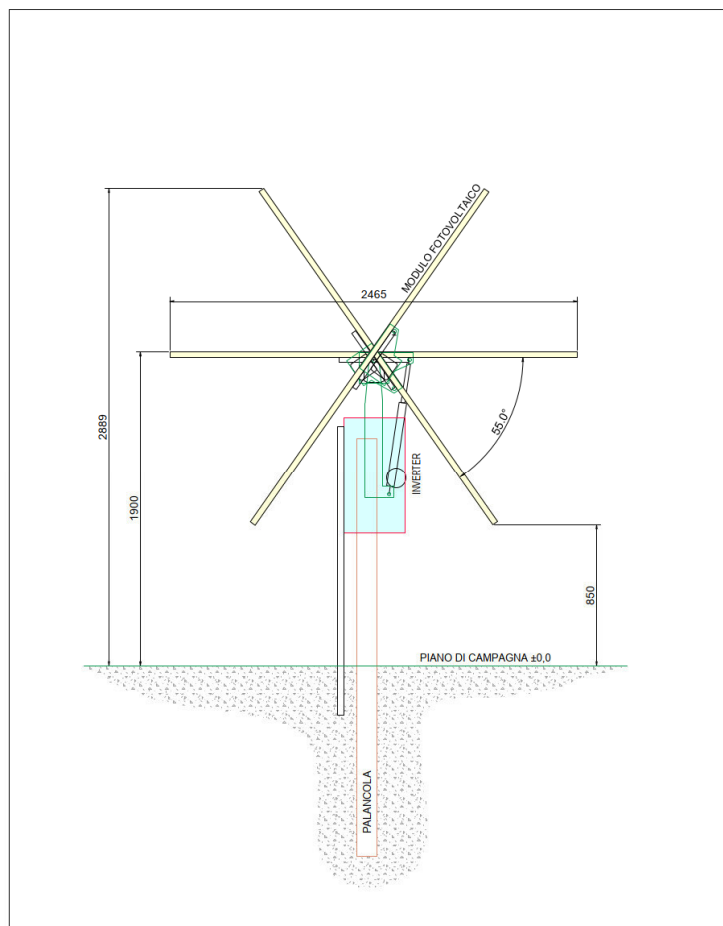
schema di montaggio dei pannelli rispetto al piano campagna
